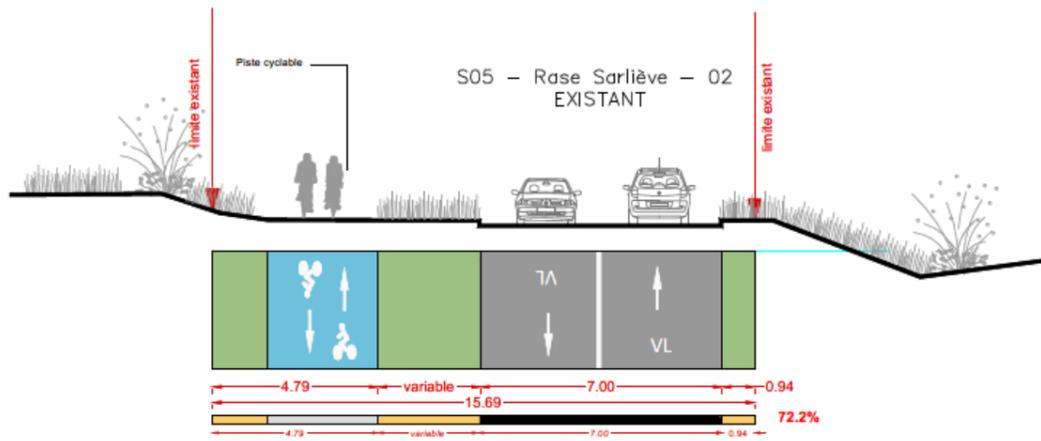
Profil existant sur la rue de Sarliève au droit du CEM
